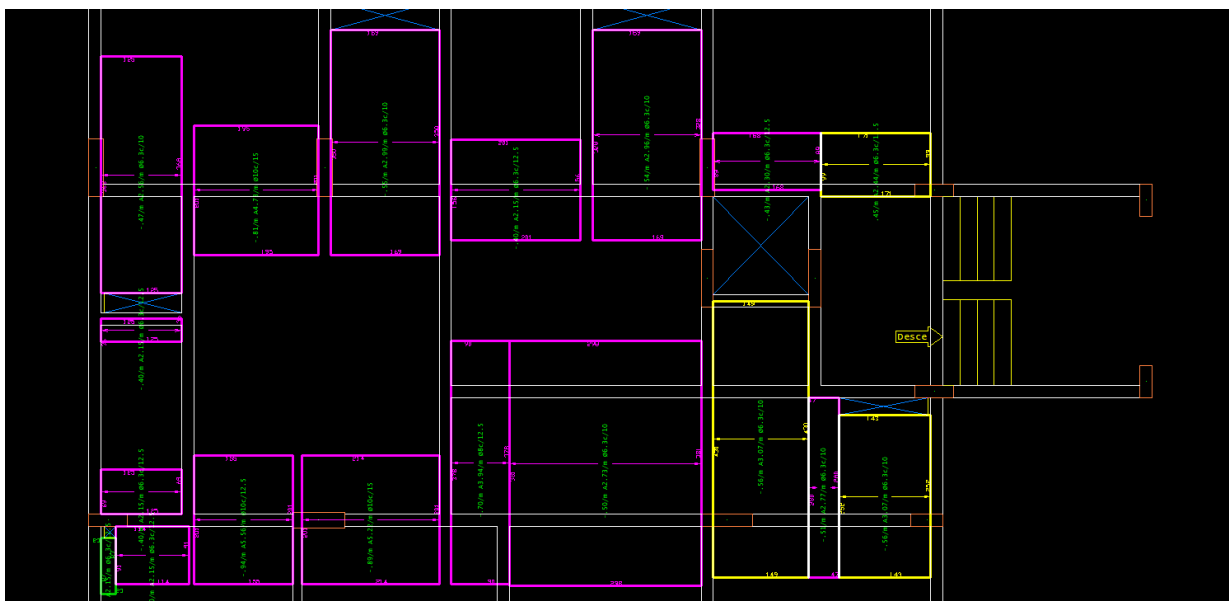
Faixas de esforços solicitantes/armadura adotada - Pavimento Tipo.
